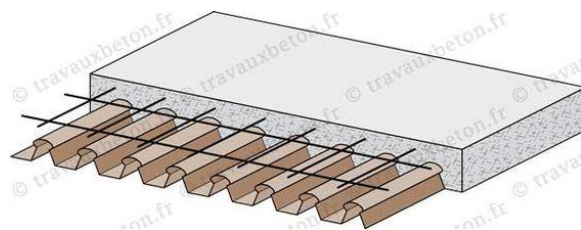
Coupe perspective Plancher Collaborant (Travauxbeton.fr)
